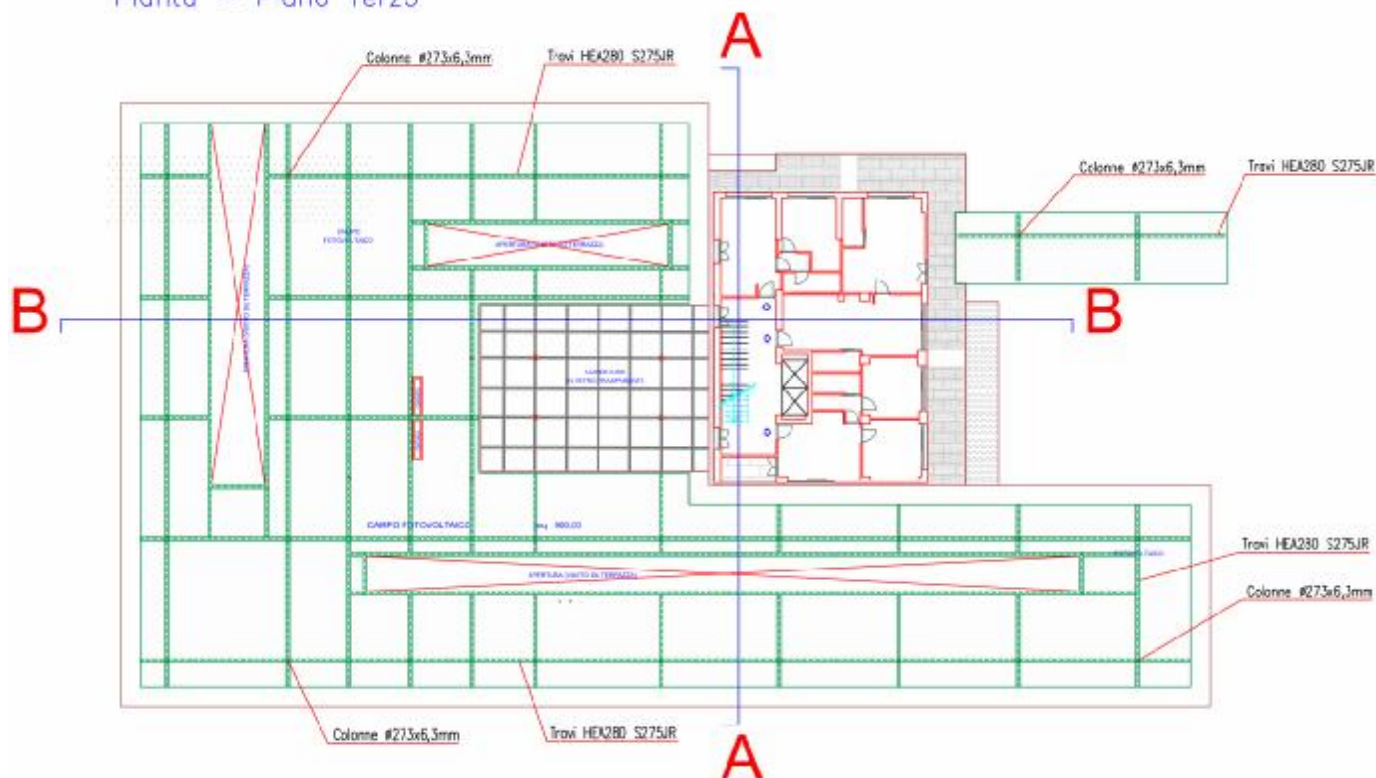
Pianta piano Terzo con "ossatura" pensilina metallica
